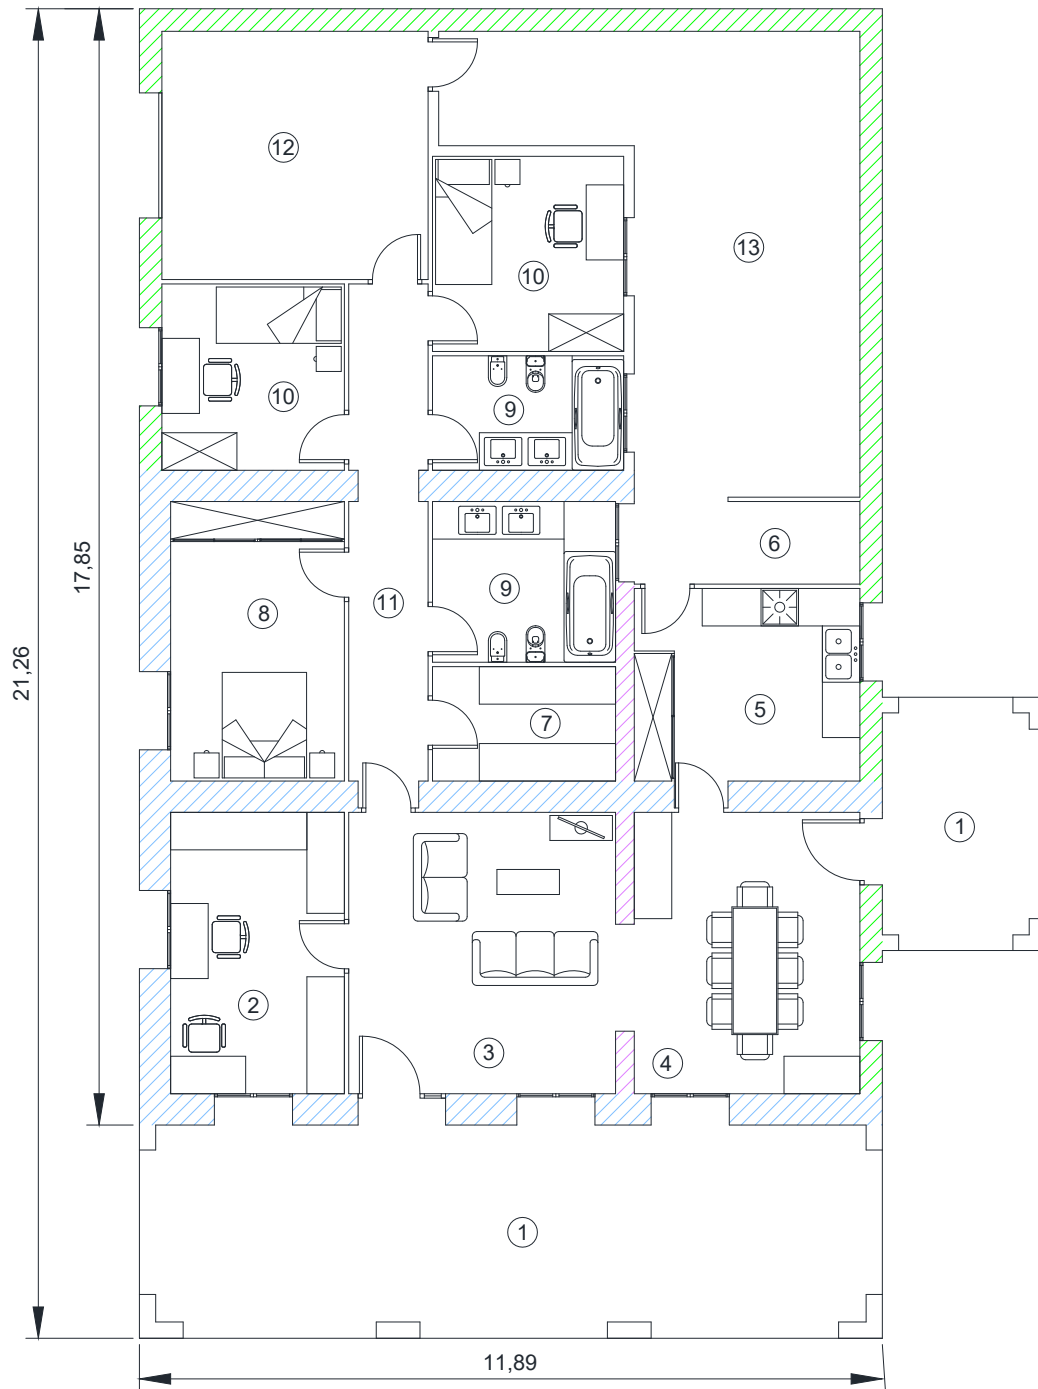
Planta de distribución del proyecto modificado de 1986
